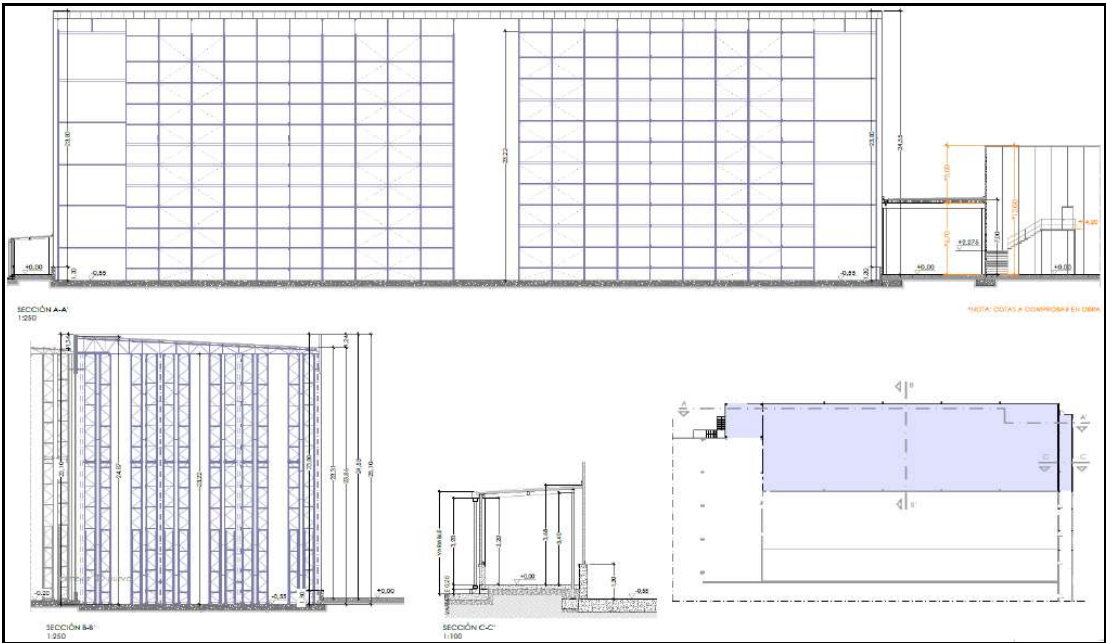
Planta general y secciones de Ampliación almacén automático.
